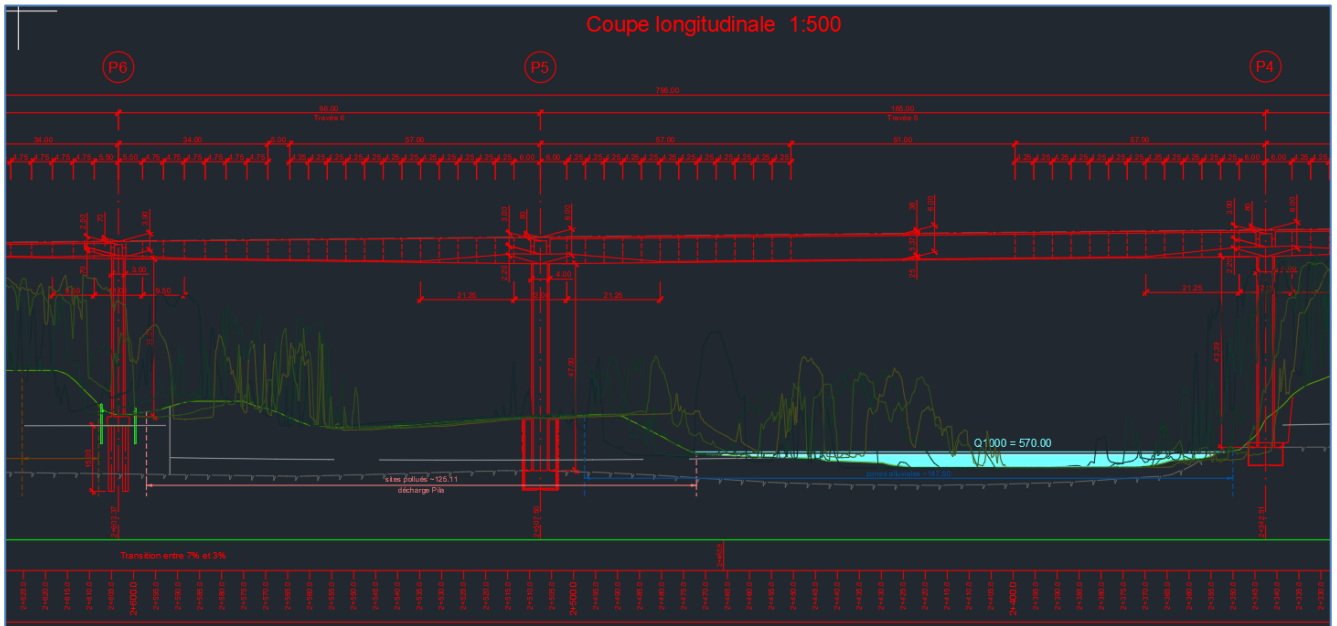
Profil en long du pont à Hauterive – Secteur avec hauteur sous pont supérieure à 30 m
